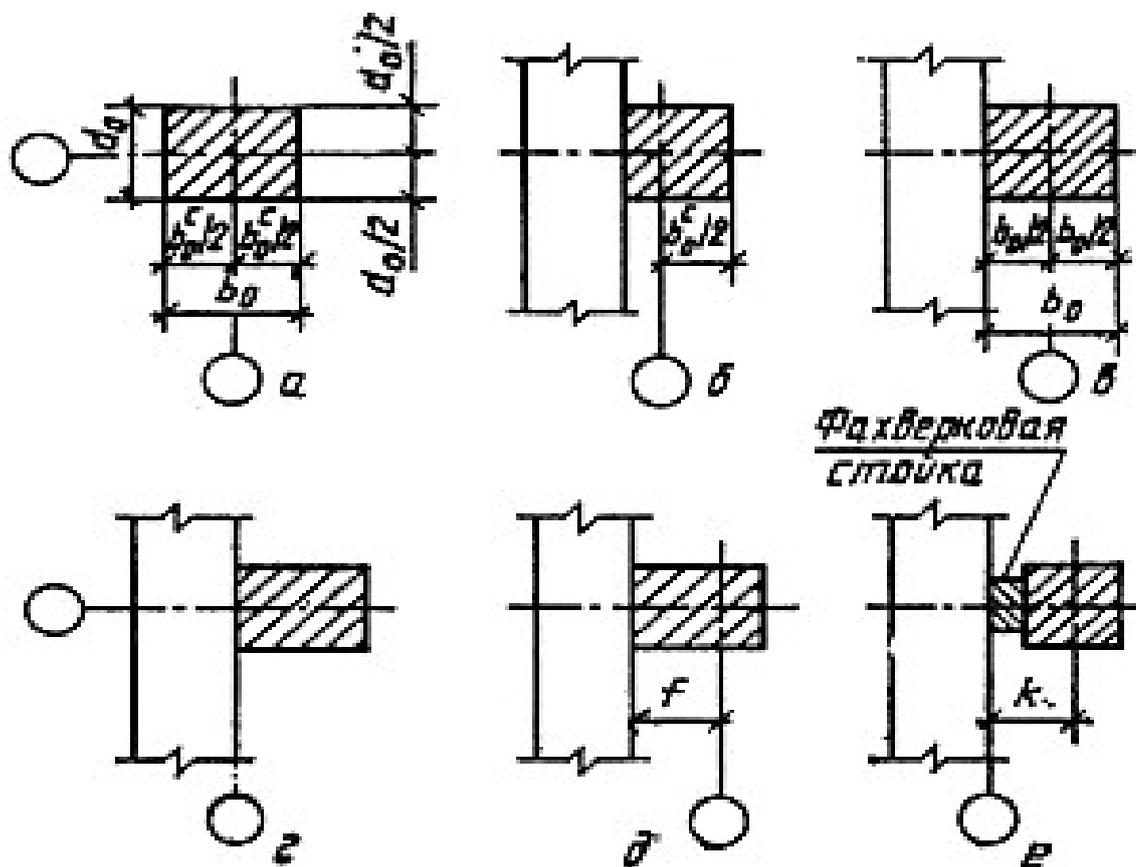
Примеры привязки колонн к координационным осям в каркасных зданиях: а – колонн средних рядов; б – г – колонн крайних рядов; в – внешнюю координационную ось колонн допускается смещать от координационных осей наружу на расстояние f , кратное модулю $3M$ и, при необходимости, M или $1/2M$; е – в торцах зданий допускается смещать геометрические оси колонн внутрь здания на расстояние k (см. «в»).
